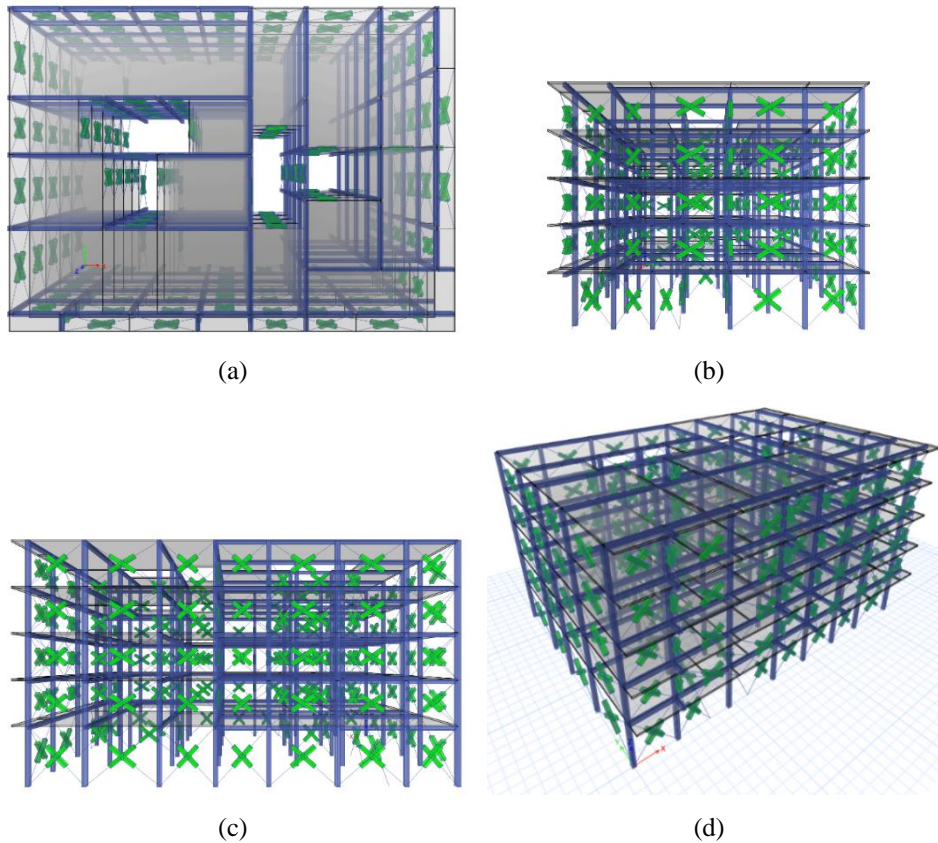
Modelo 3D del edificio la viña. (a) vista superior (b) fachada transversal (c) fachada longitudinal (d) vista 3D. Las cruces verdes corresponden a los elementos *link* y las líneas azules a los elementos tipo *frame*.
